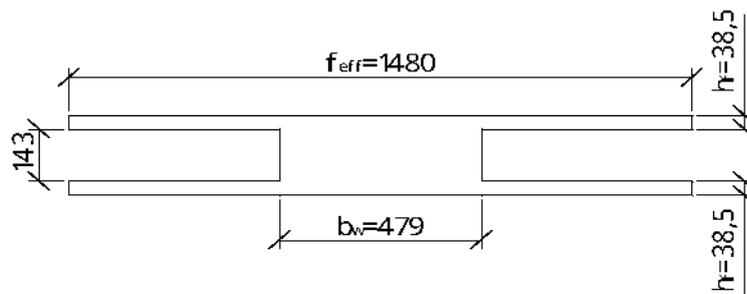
Приведений переріз багатопустотної плити до двотаврового.
